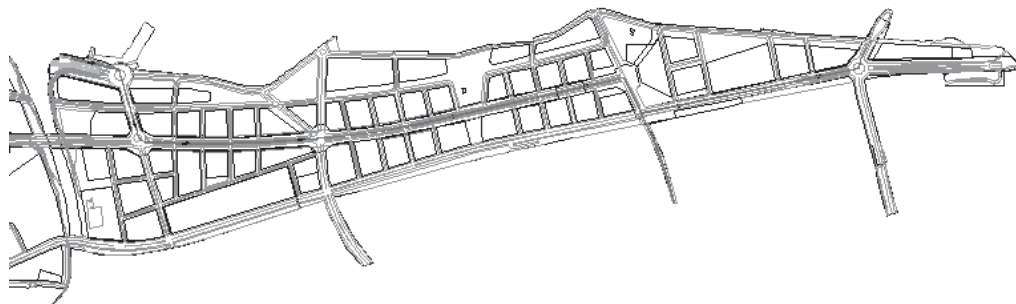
Trazado de las alcantarillas principales de saneamiento bajo los viales comunes en la zona al norte de Calle 30
